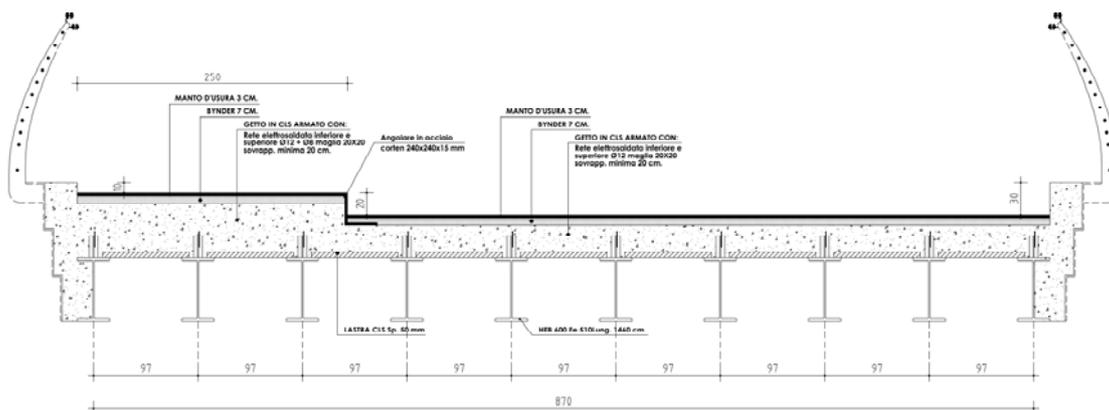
Sezione trasversale di un impalcato stradale di recente costruzione
